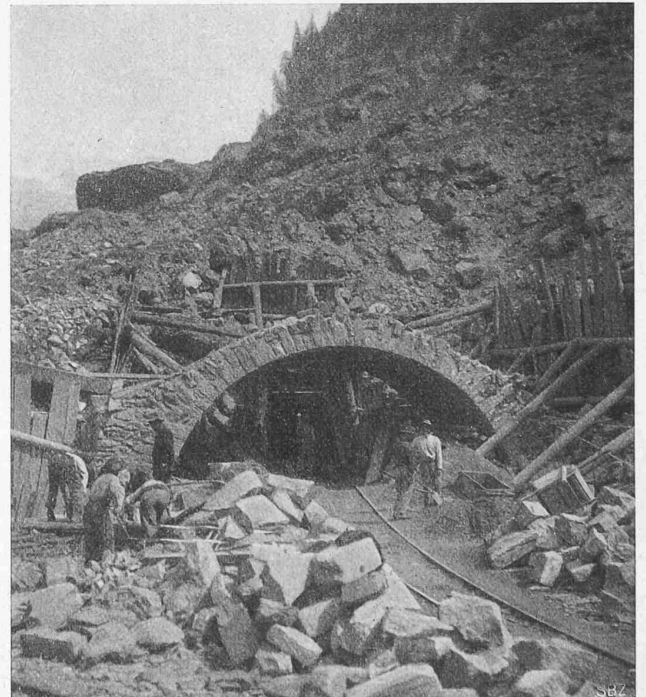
Rotlauenen-Tunnel, Gewölbe-Tagbau Seite Brig.
